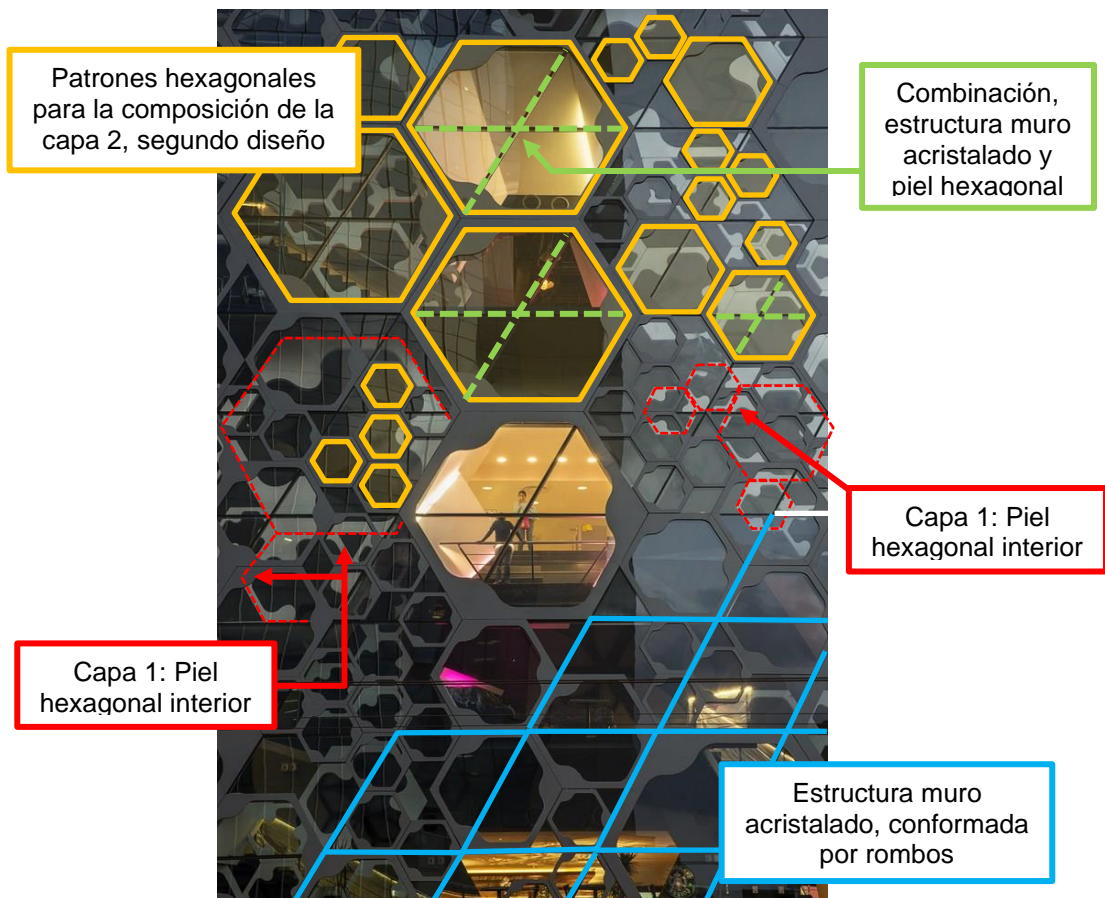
Vista de piel y muro acristalado, Tienda Departamental Liverpool Insurgentes
